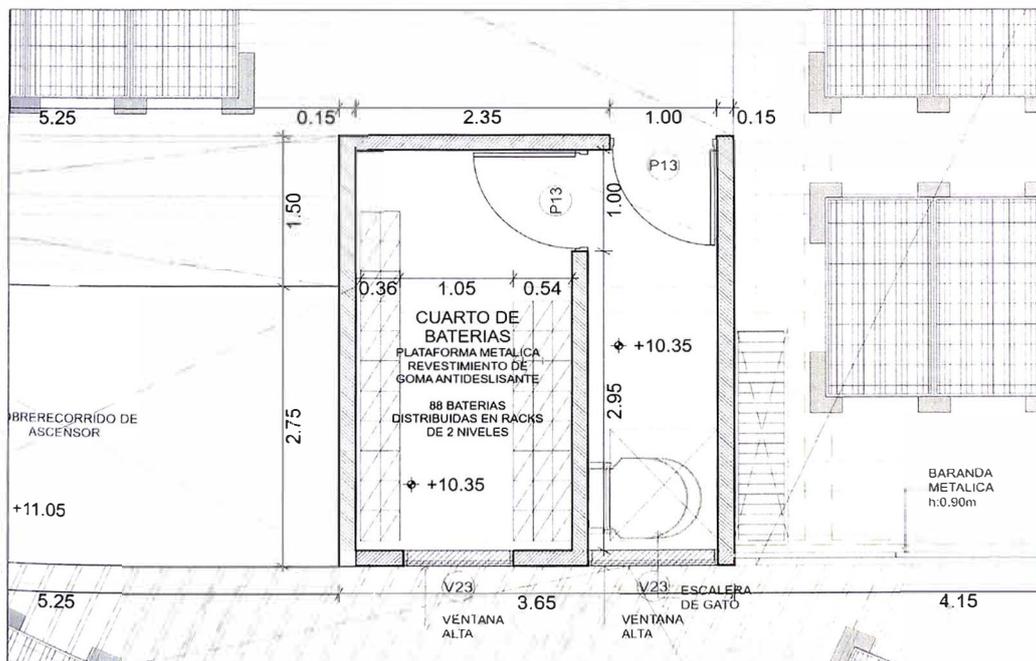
Distribución del cuarto de baterías en planta de techos.
